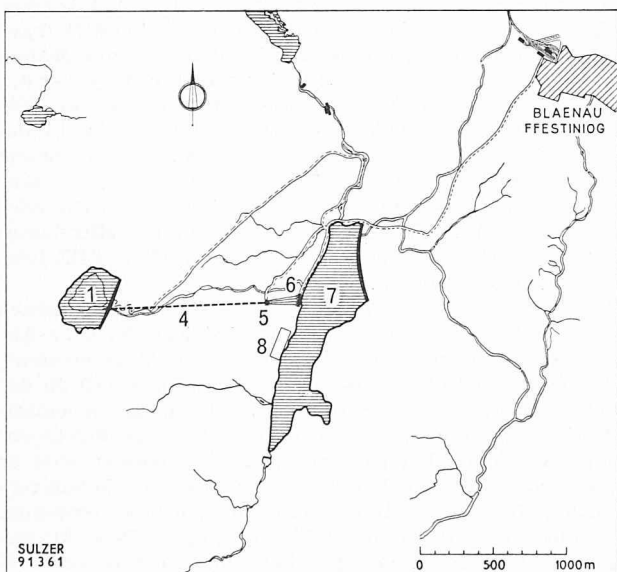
Lageplan des Pumpspeicherwerkes, 1:50 000
